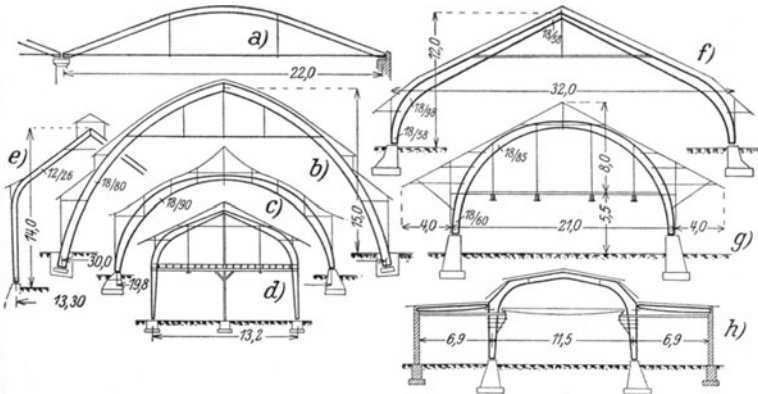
Vollwandige Hallenbinder nach Bauweise Hetzer. a) Zweigelen-Flachbogen mit Zugband. b) Sängerhalle in Küfnacht bei Zürich. c) Reithalle in St. Moritz; Dachsparren wenig gebogen, darauf eine mit Dachleinwand überspannte Holzschalung. d) Holzlagerschuppen mit Ziegeleindeckung und Zwischen-decke für 1200 kg/m<sup>2</sup> Nutzlast. e) Hochstieller Dreigelenkbogen. f) Flachere Dreigelenkbogen. g) Rahmen mit angehängter Nutzdecke. h) Maschinenhalle; Stützen mit 12 t Kranbahndruck.
